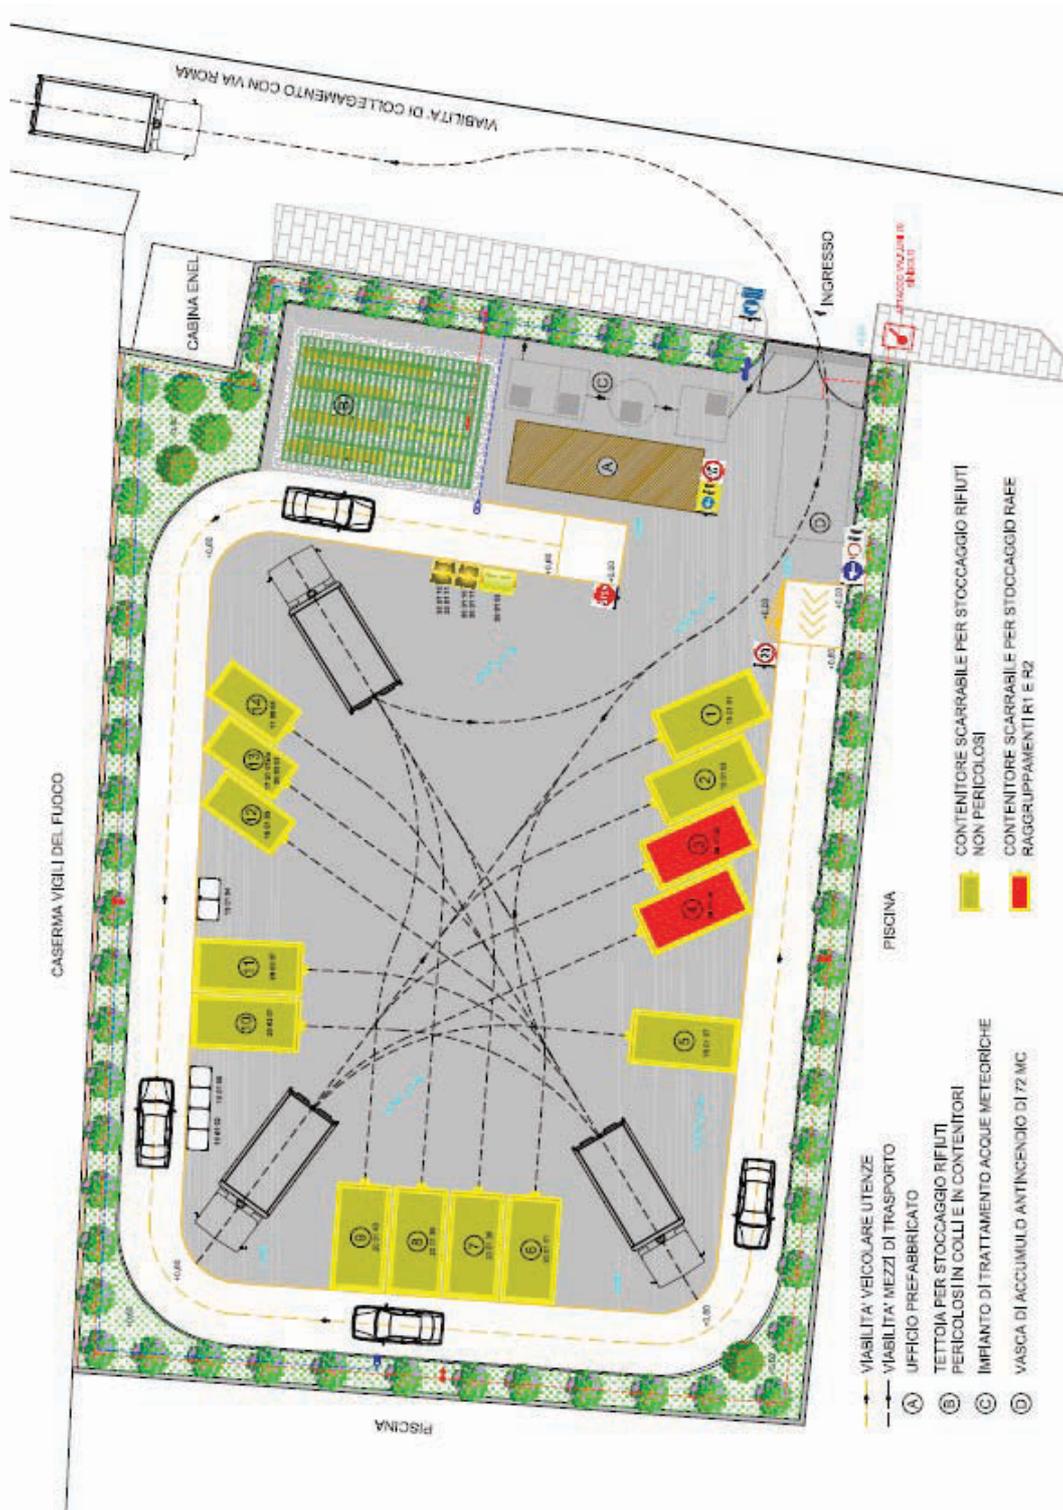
Planimetria tipo di Centro Comunale di Raccolta
